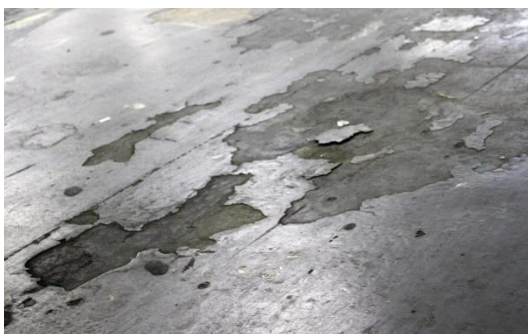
Fissura em piso de concreto - Fonte: <http://techne.pini.com.br/>
